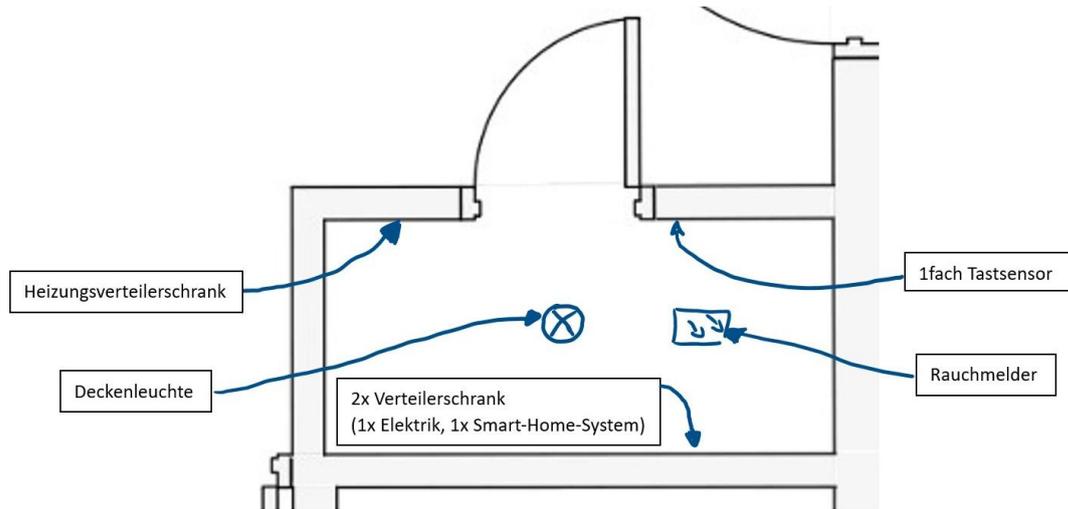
Grundriss Abstellraum mit Geräten
